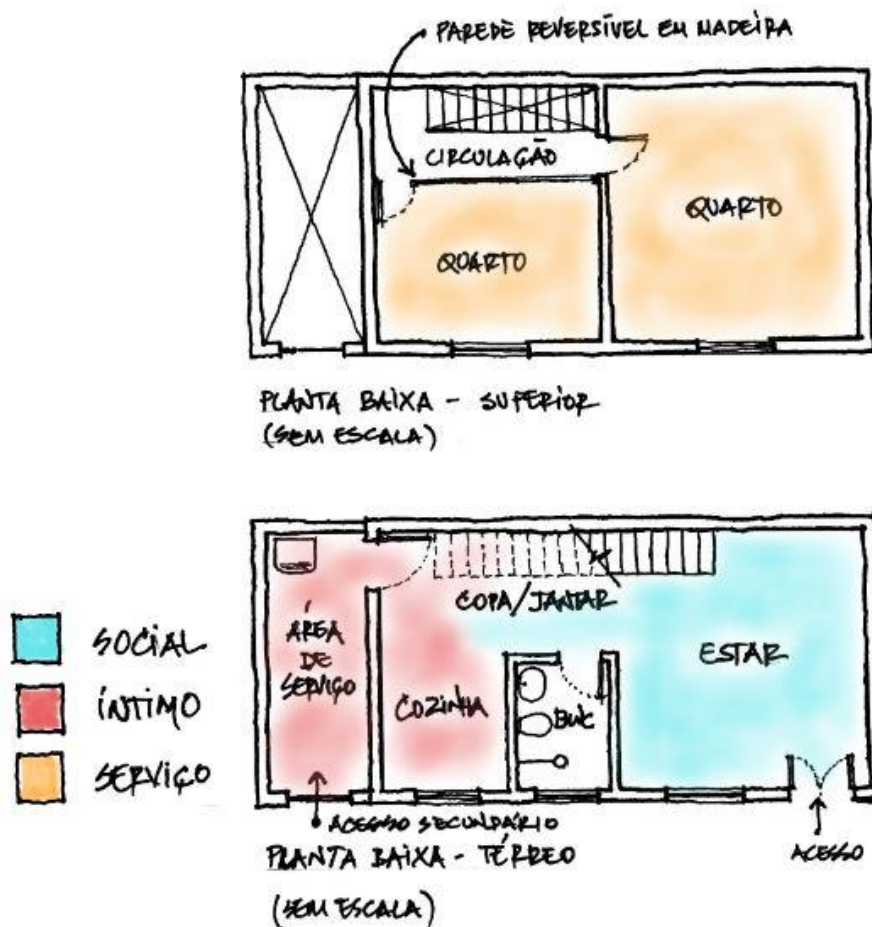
Croqui esquemático com plantas dos pavimentos térreo e superior da Vila Sr. Christiano Marques.
